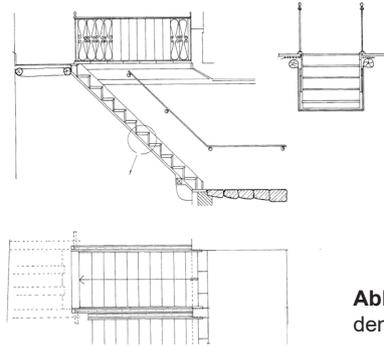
Treppen zwischen zwei Wänden, Holzbalken- Grundriss & Schnitt
